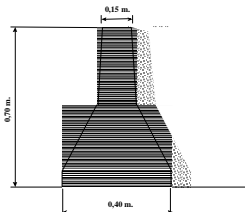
Barrera portátil de hormigón – Medidas mínimas
